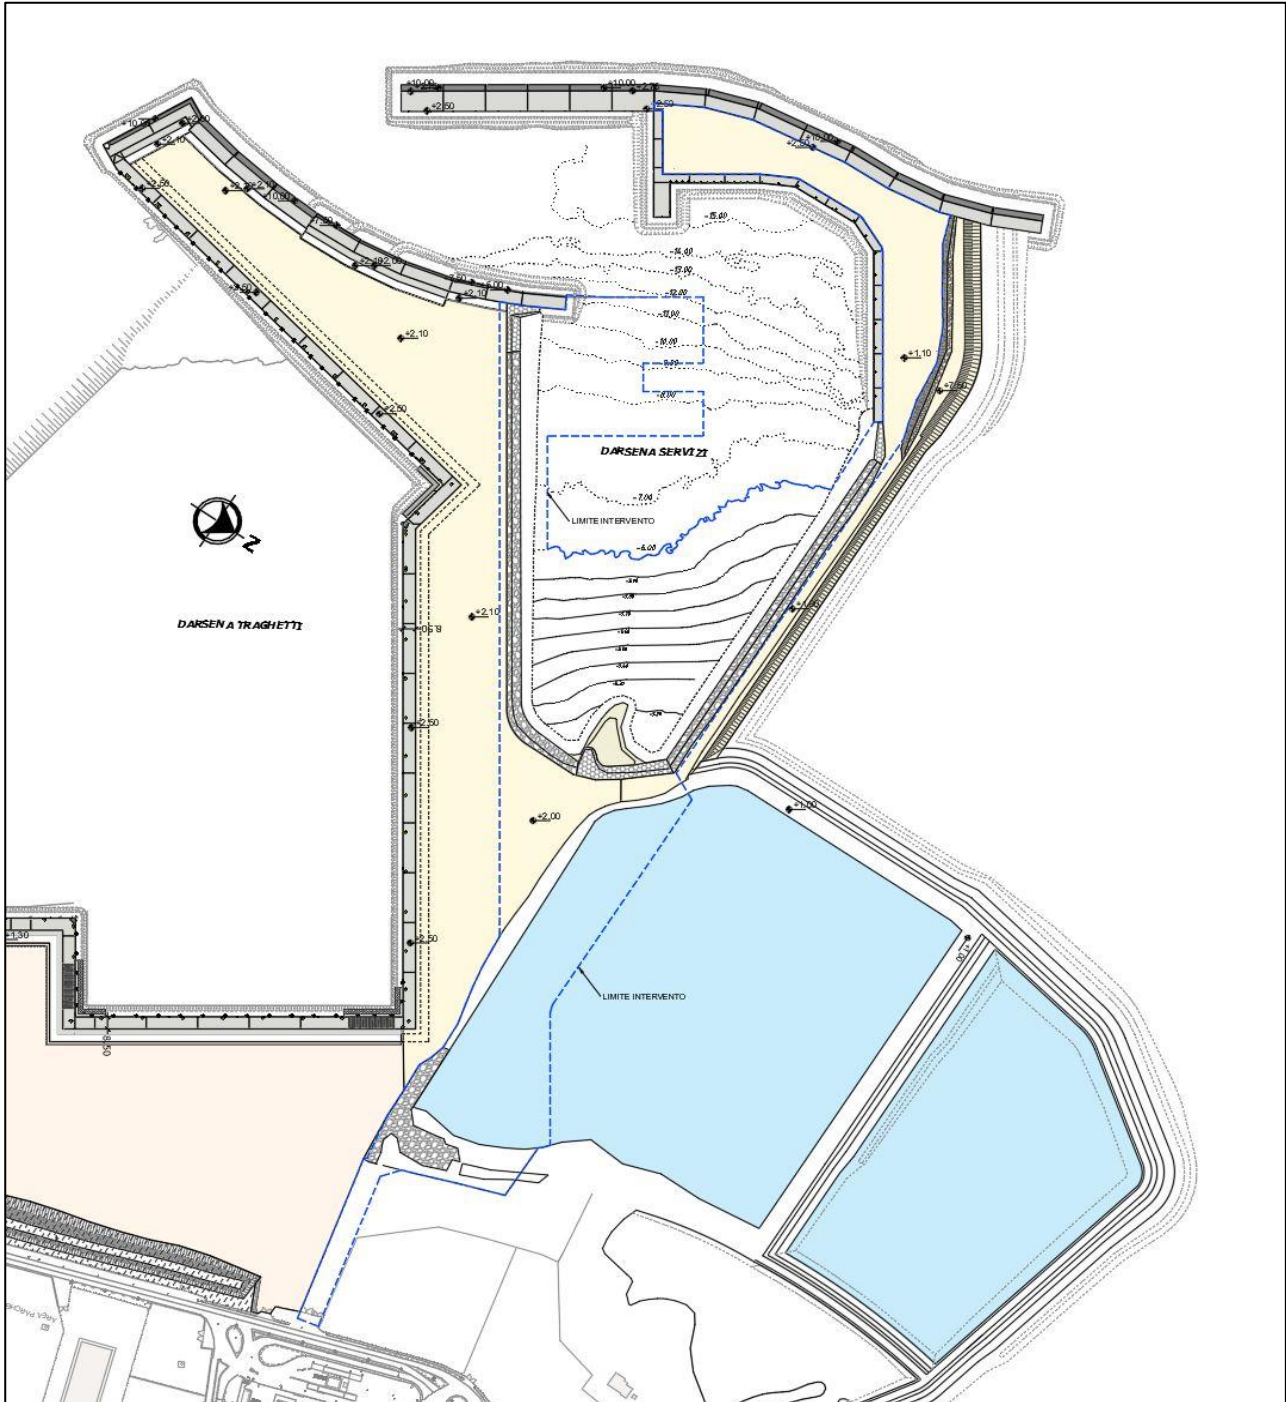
Planimetria dello stato attuale con andamento plano-batimetrico e sagoma dell'intervento
